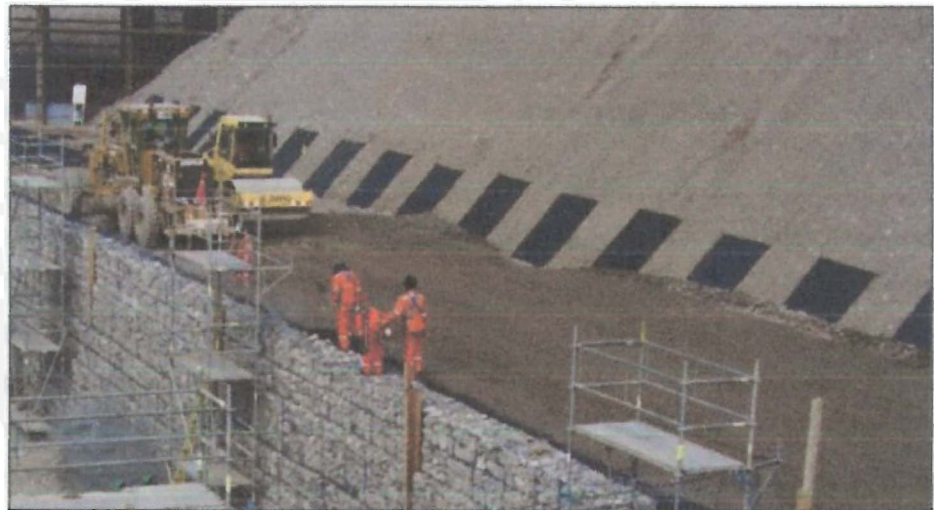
Sistema de Drenaje instalado posterior al muro
